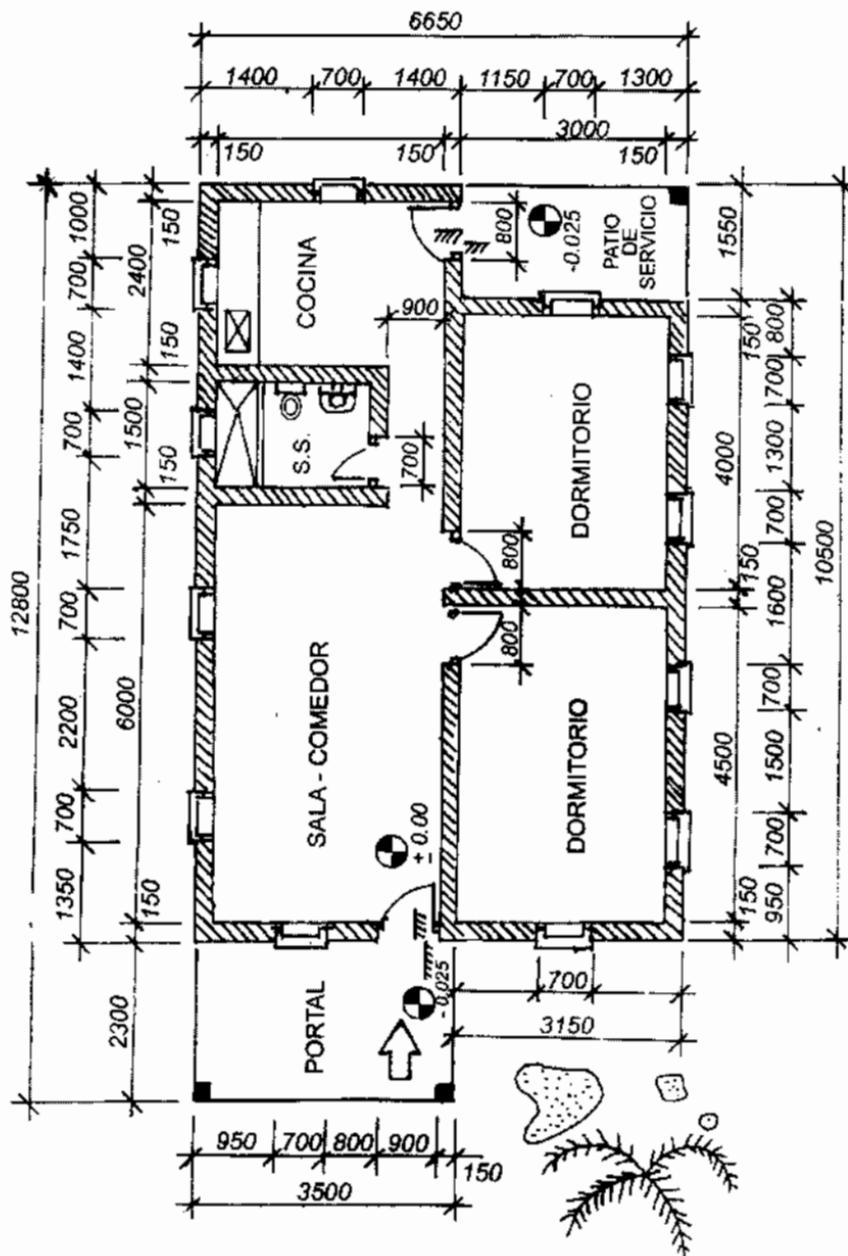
C ESQUEMA DE PLANTA VARIANTE TRADICIONAL
